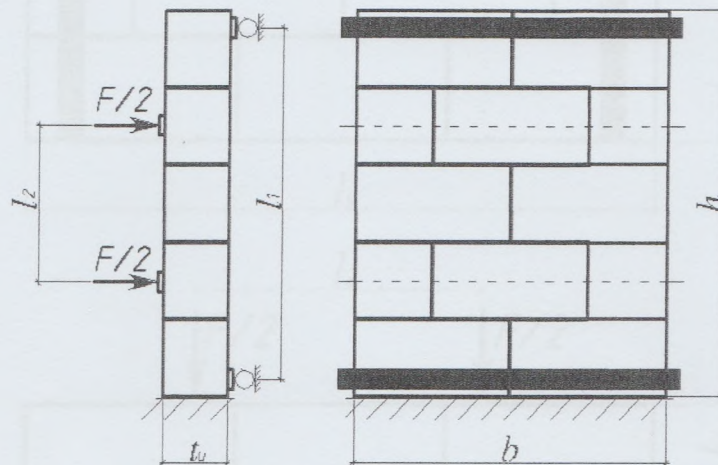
Схема испытаний кладок на изгиб по неперевязанному сечению
